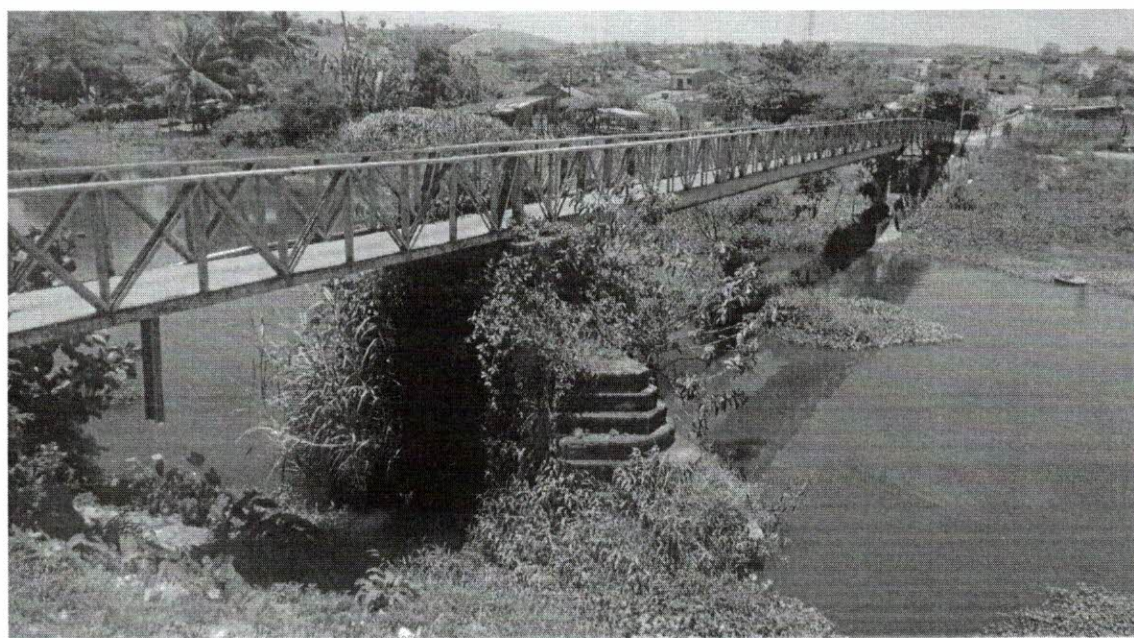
Vista Lateral do local onde será implantado a ponte sobre o rio Canhoto
